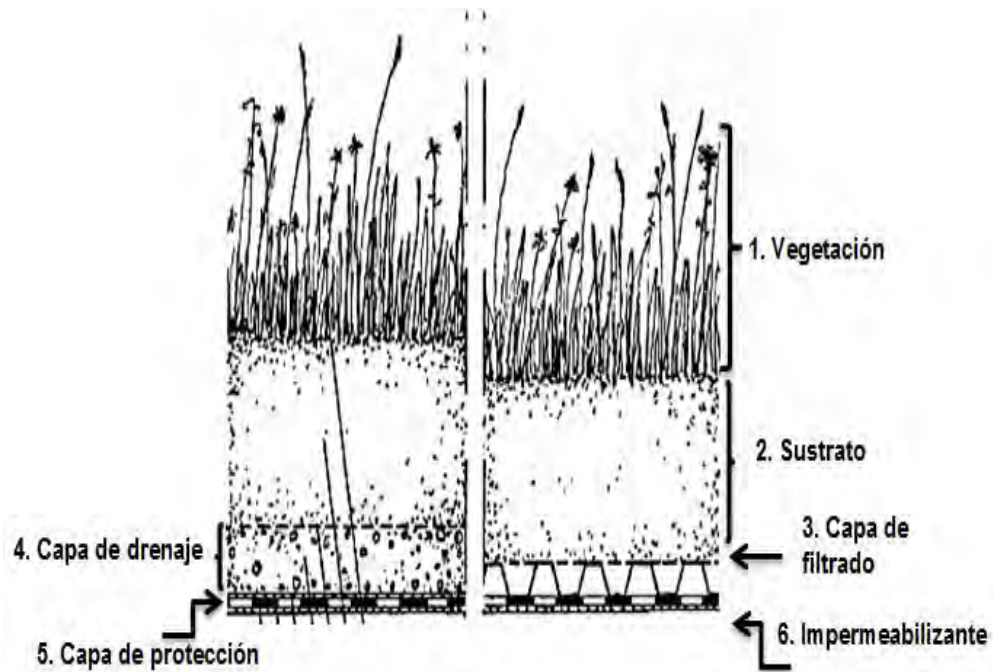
Construcción de capas de enjardinados para techos planos
